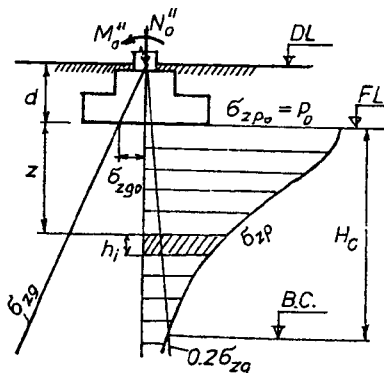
Схема к расчету осадки фундамента методом послойного суммирования
